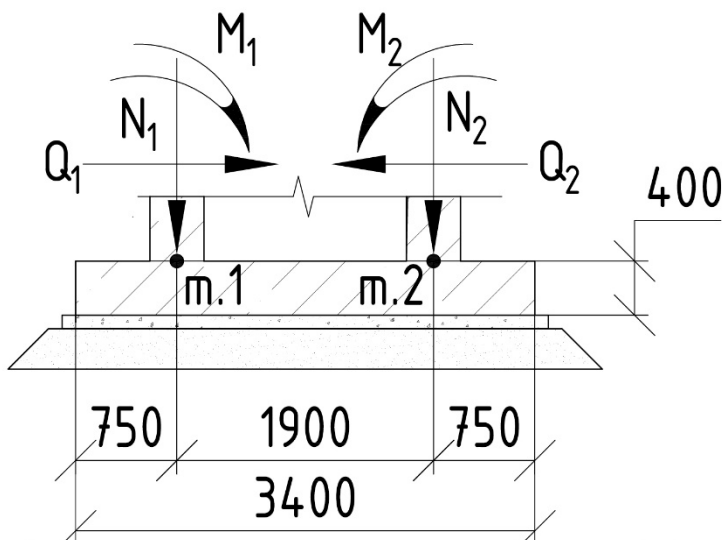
Схема навантажень на фрагмент фундамента плити умовною шириною 1,1 м (без урахування власної ваги плити) в рівні її верхнього обрізу.
